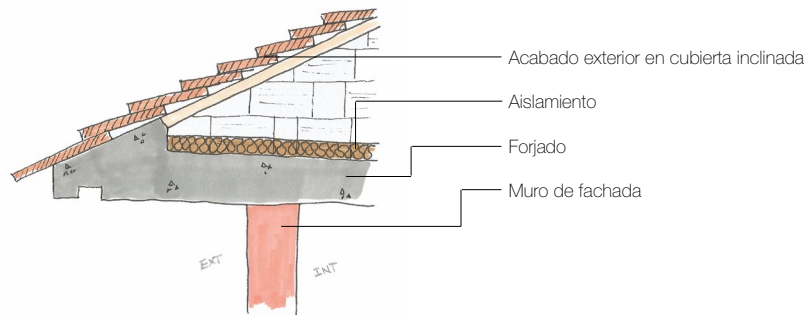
Detalle genérico en sección de aislamiento bajo cubierta (inclinada) (autoría propia).
